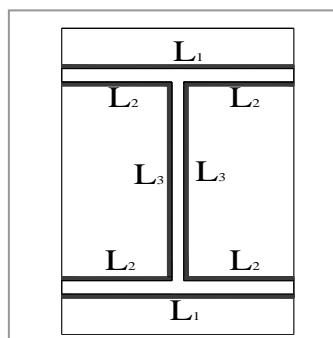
Assemblage soudé poutres –platine.
